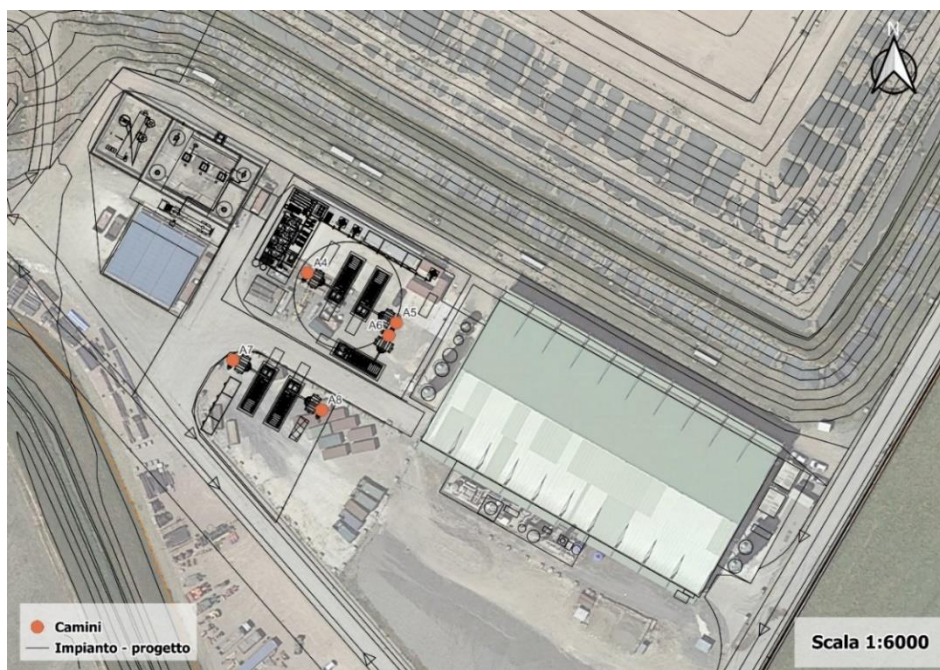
Dettaglio camini A4, A5, A6, A7 ed A8 con disegno progetto impianto
